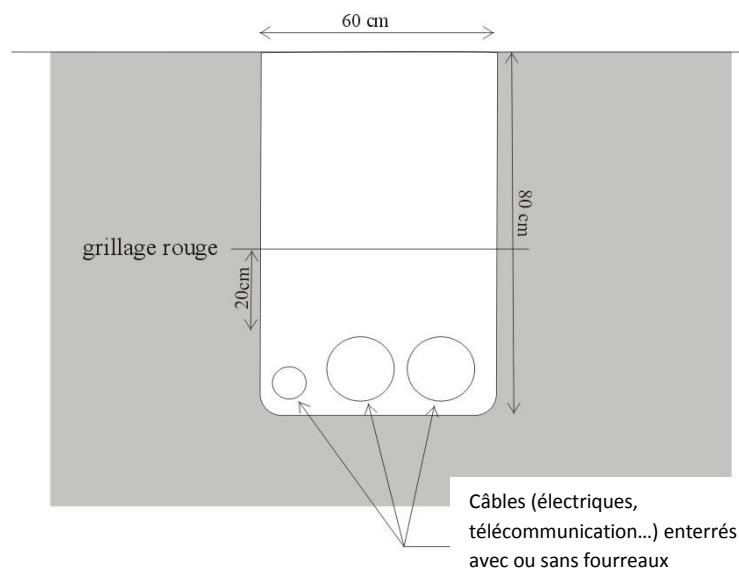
coupe d'une tranchée standard pour l'enterrement des câbles électriques
